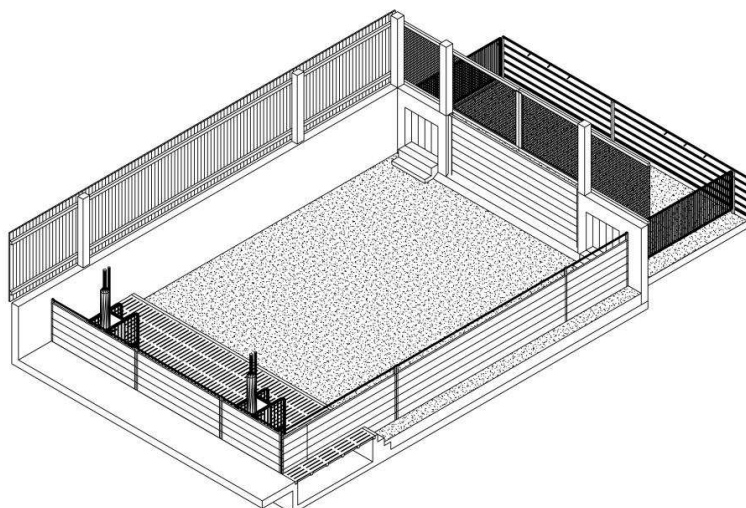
Pavimentazione con lettiera e area di alimentazione fessurata
